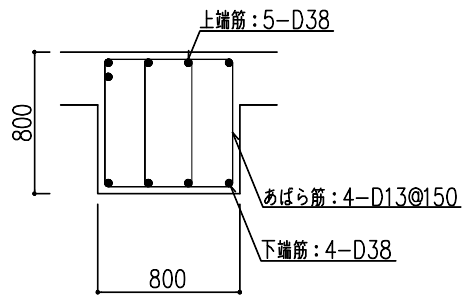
大ばりの配筋図 (2階, X8a 通り YM~YN 通り間, 端部) (単位: mm)
